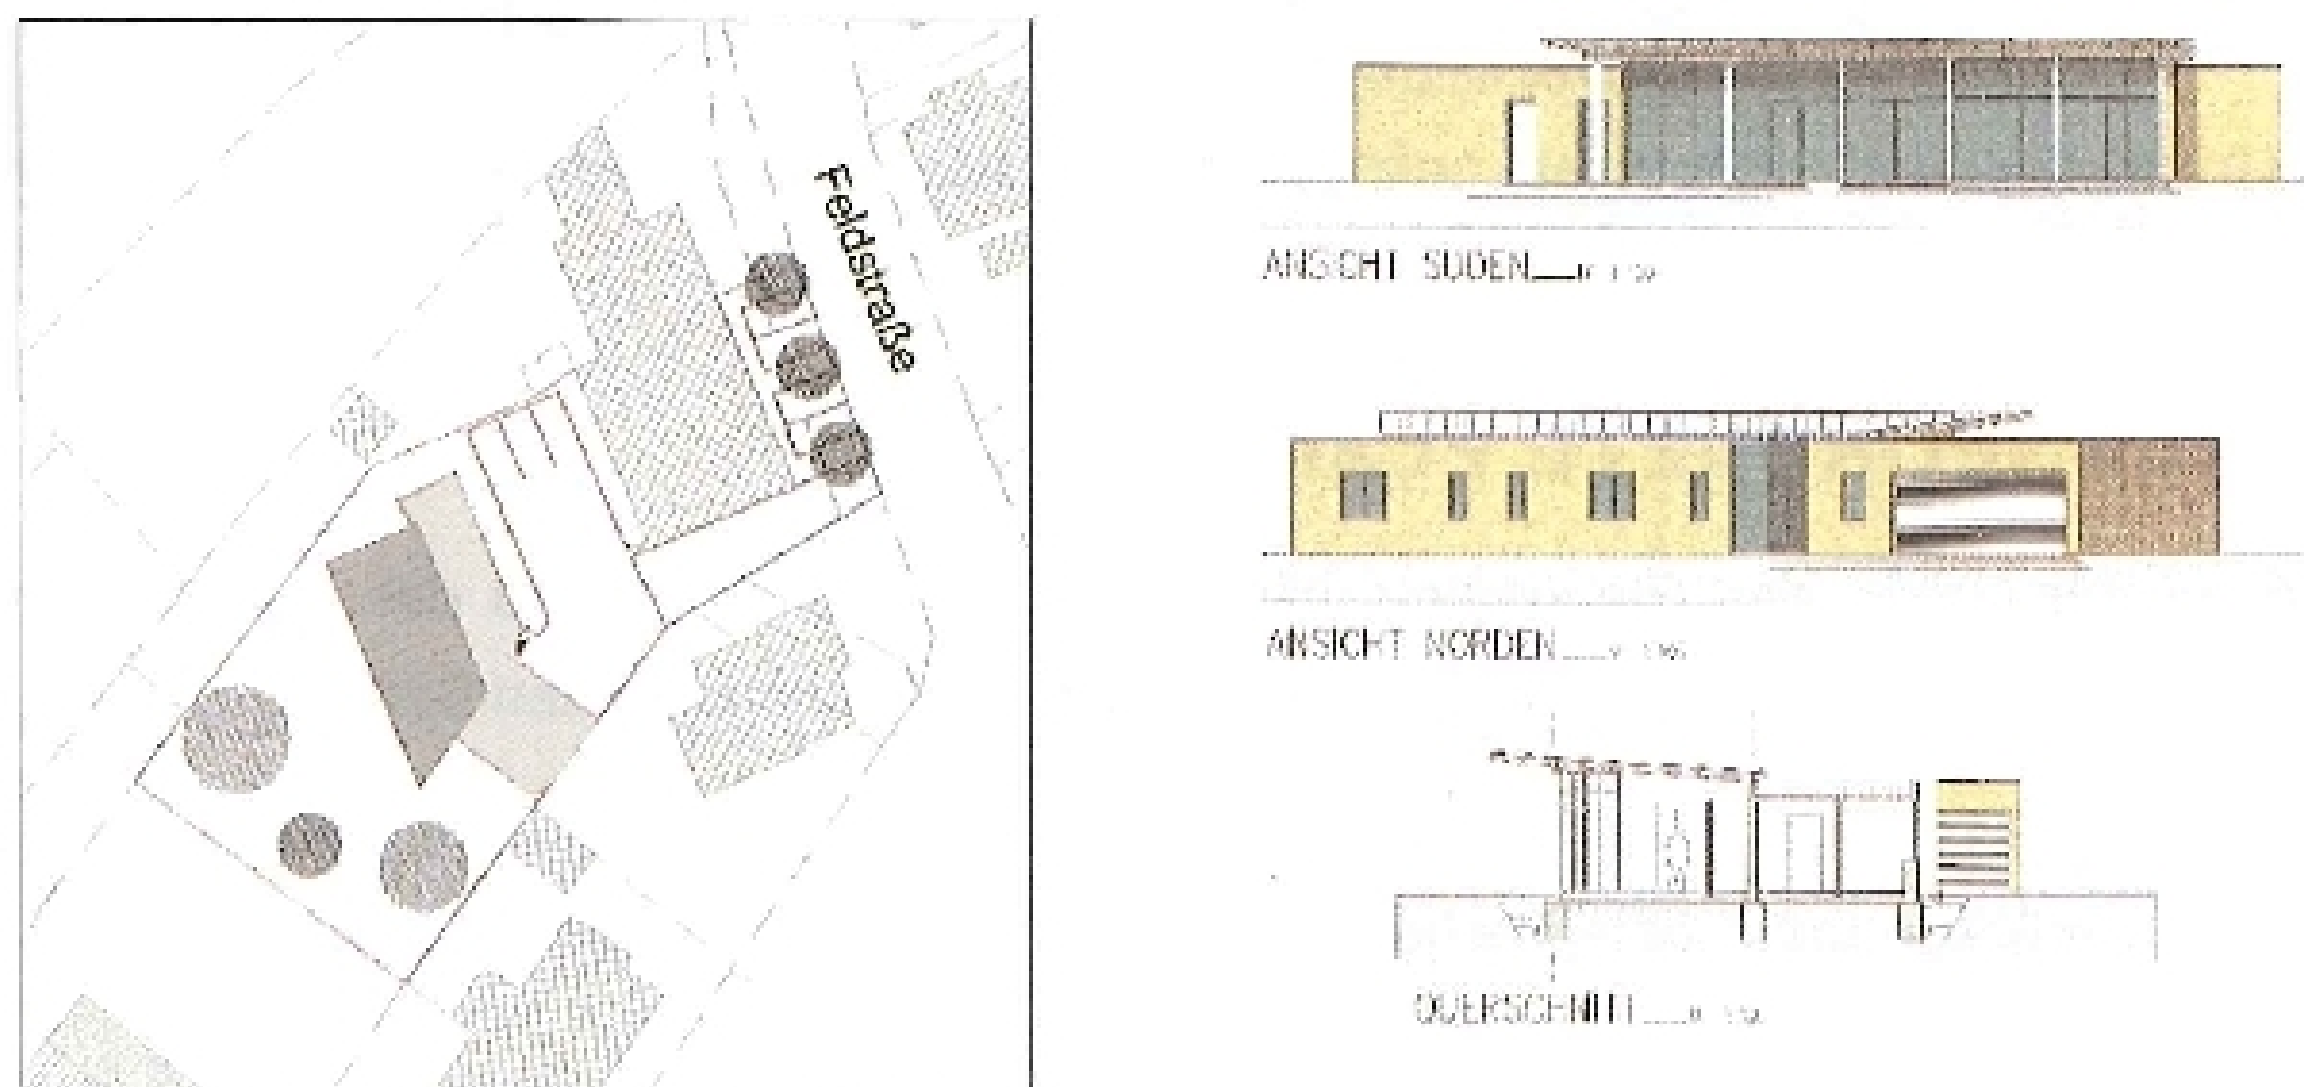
Lageplan, Ansichten und Schnitt des geplanten Wohnhauses
